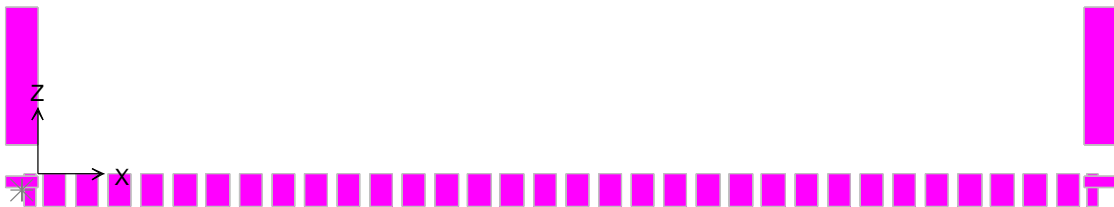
Modello di calcolo con vista estrusa delle sezioni strutturali
